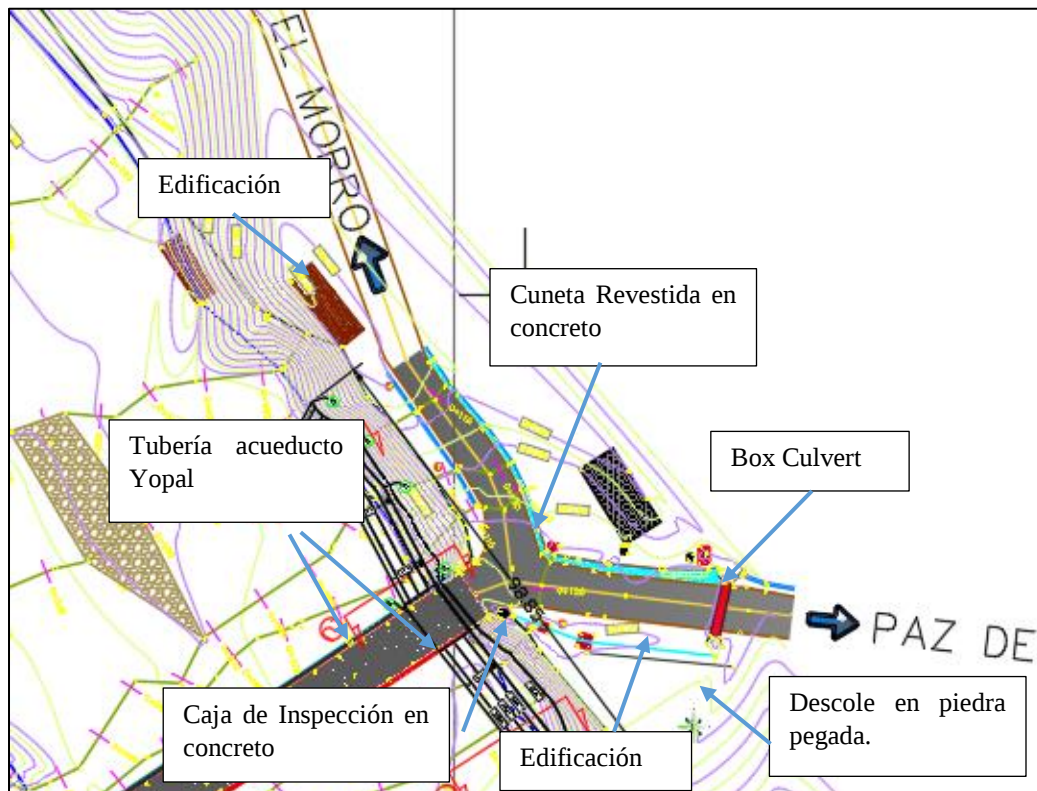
Vista en planta edificaciones y otras obras ubicadas en la zona Oriental del puente. Fuente: edición plano levantamiento topográfico Consorcio IPV.
